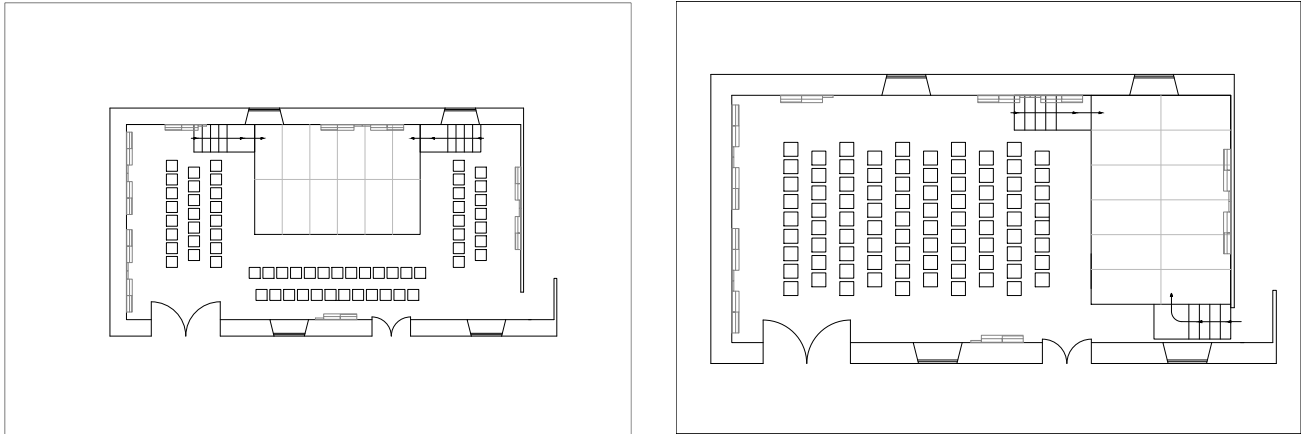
Planta de proposta aproximada da zona de auditório em duas disposições propostas distintas. Elaborado por: Vera Sancho
